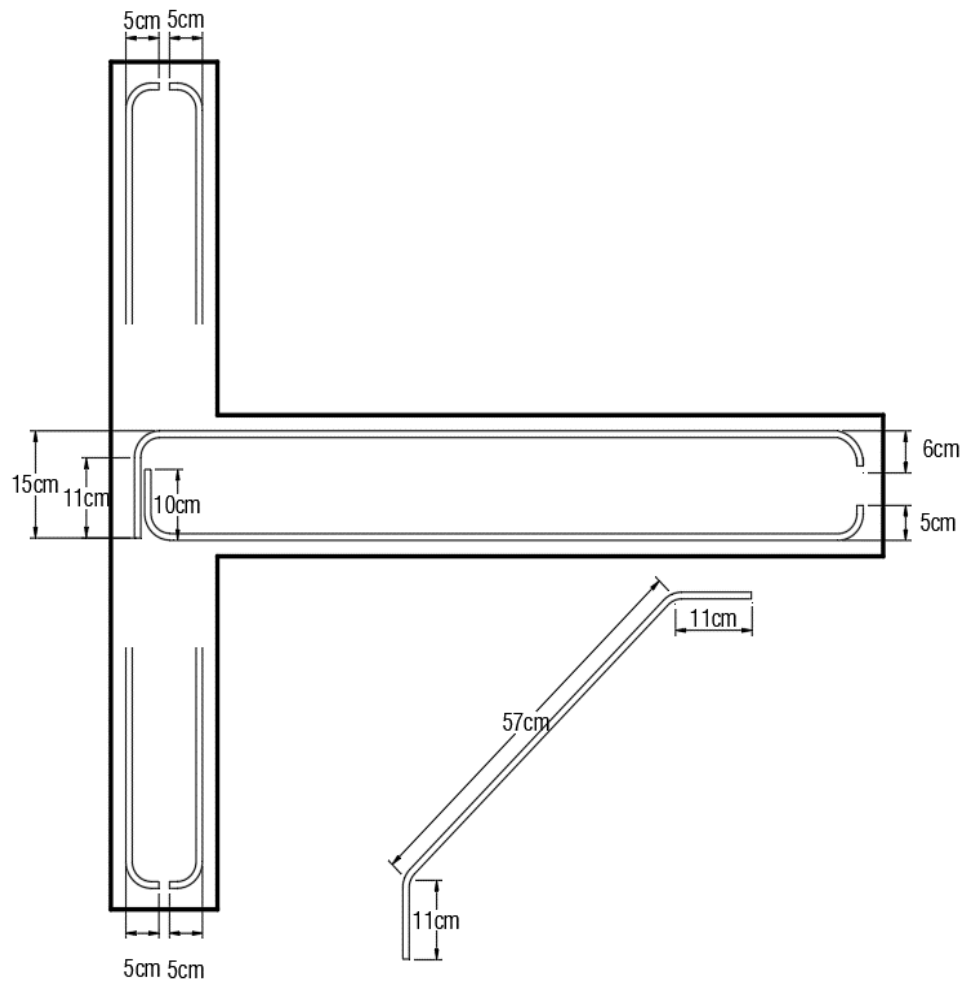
DETALLE DEL ACERO DE REFUERZO DEL ESPECIMEN Fuente: Elaboración Propia
